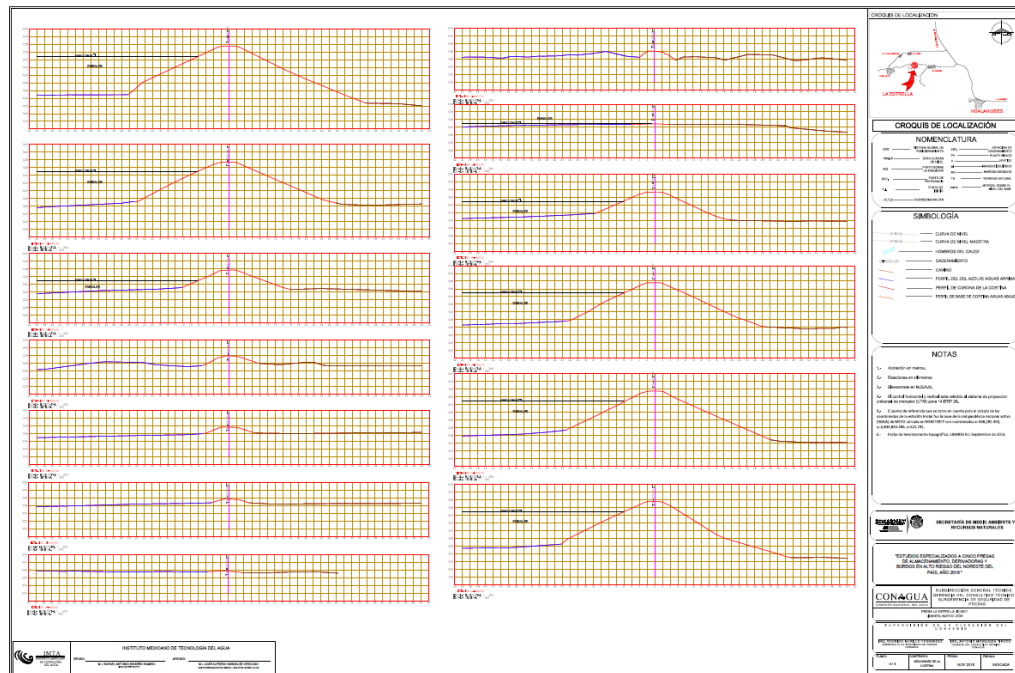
Plano de secciones de la cortina de la presa La Estrella.
